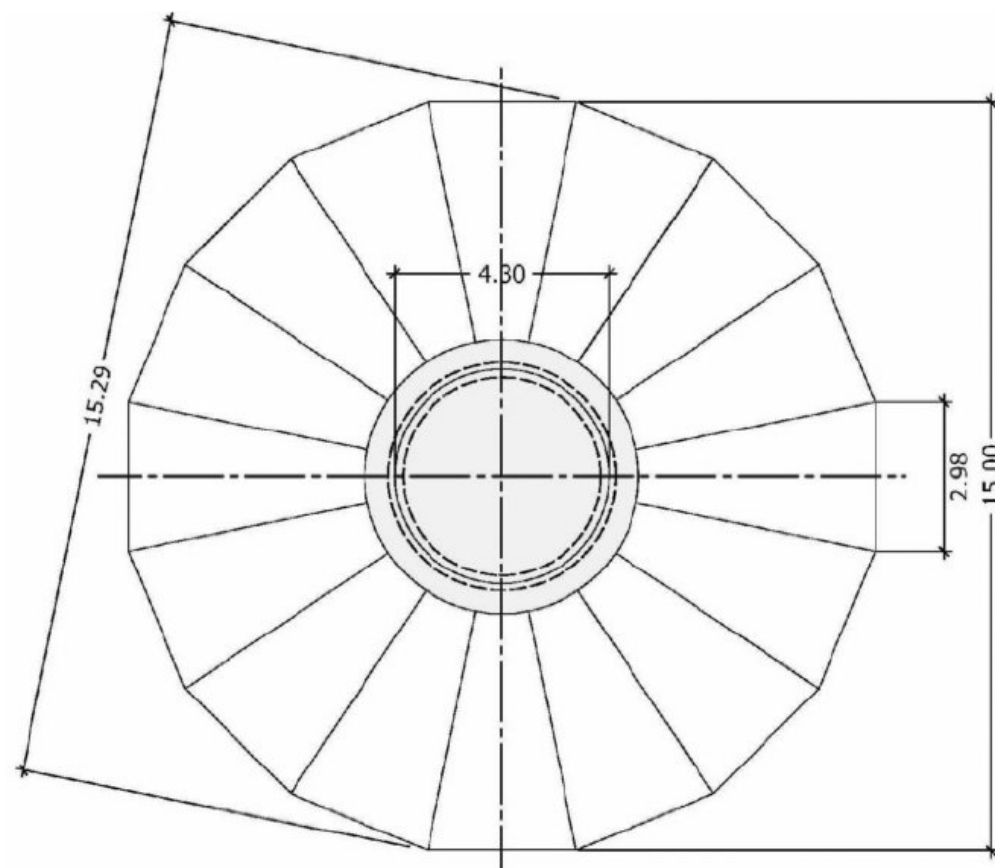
Vue en plan de fondation d'éolienne de type massif poids – MM92 (Source : SENVION)
